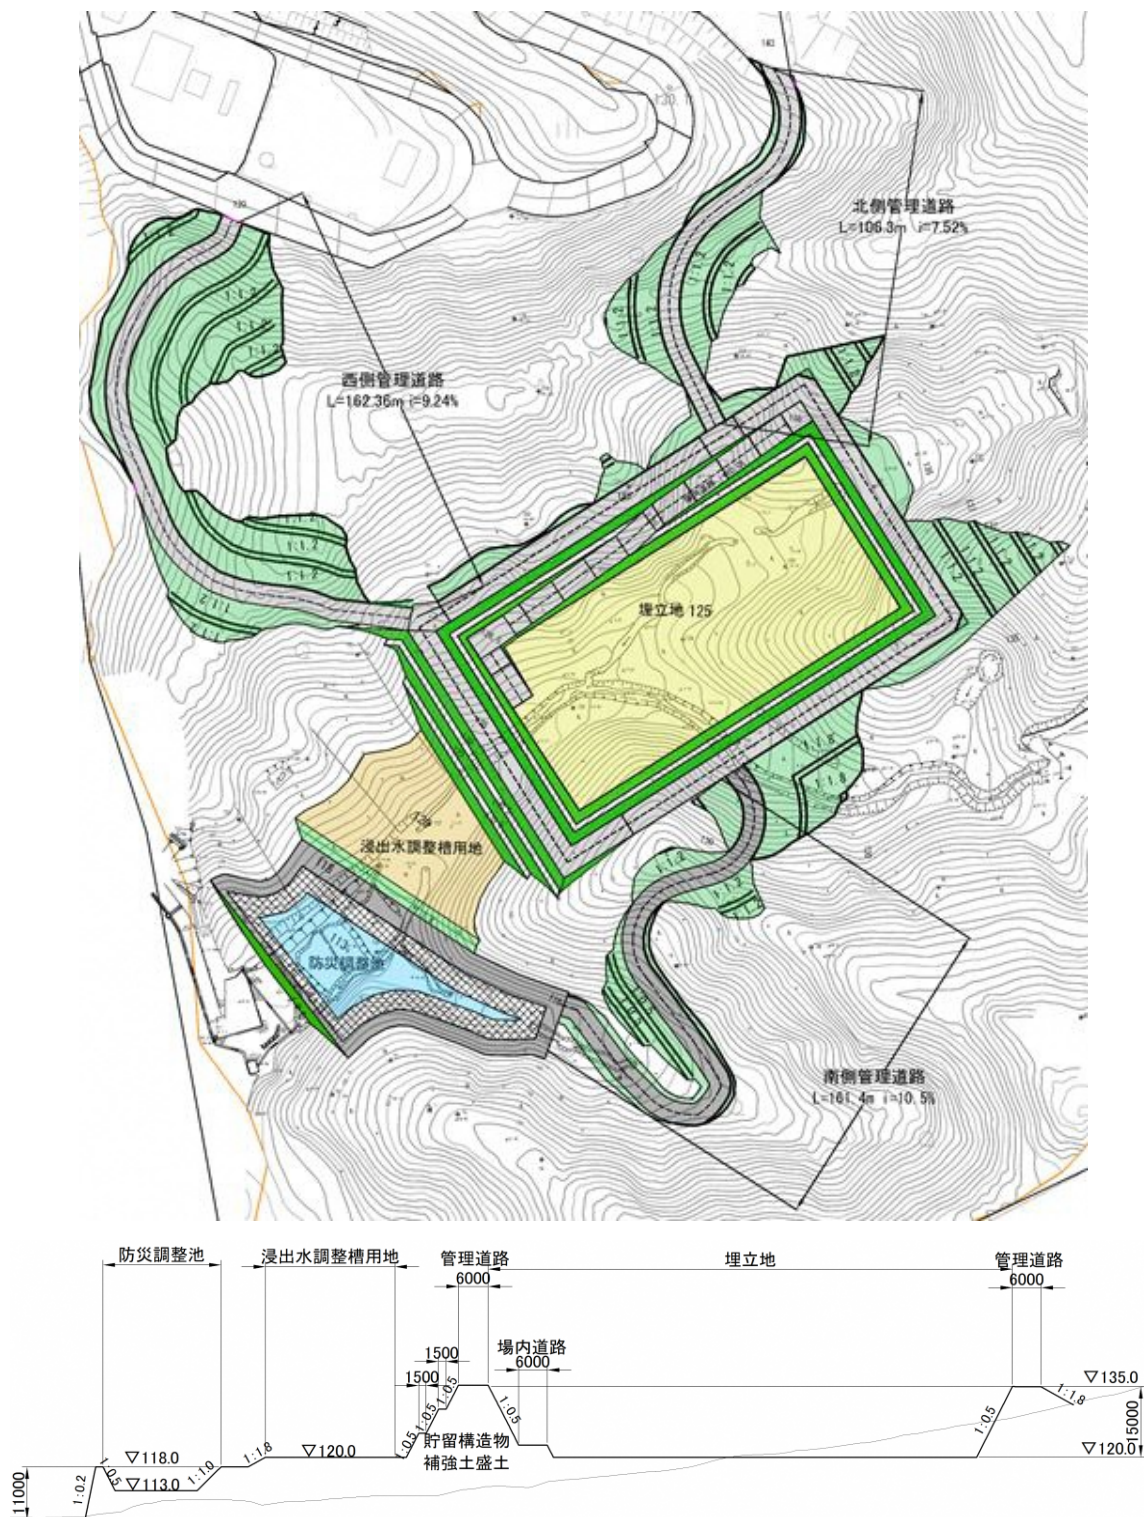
基本計画 (案3) 平面図 (上)、標準断面図 (下)
